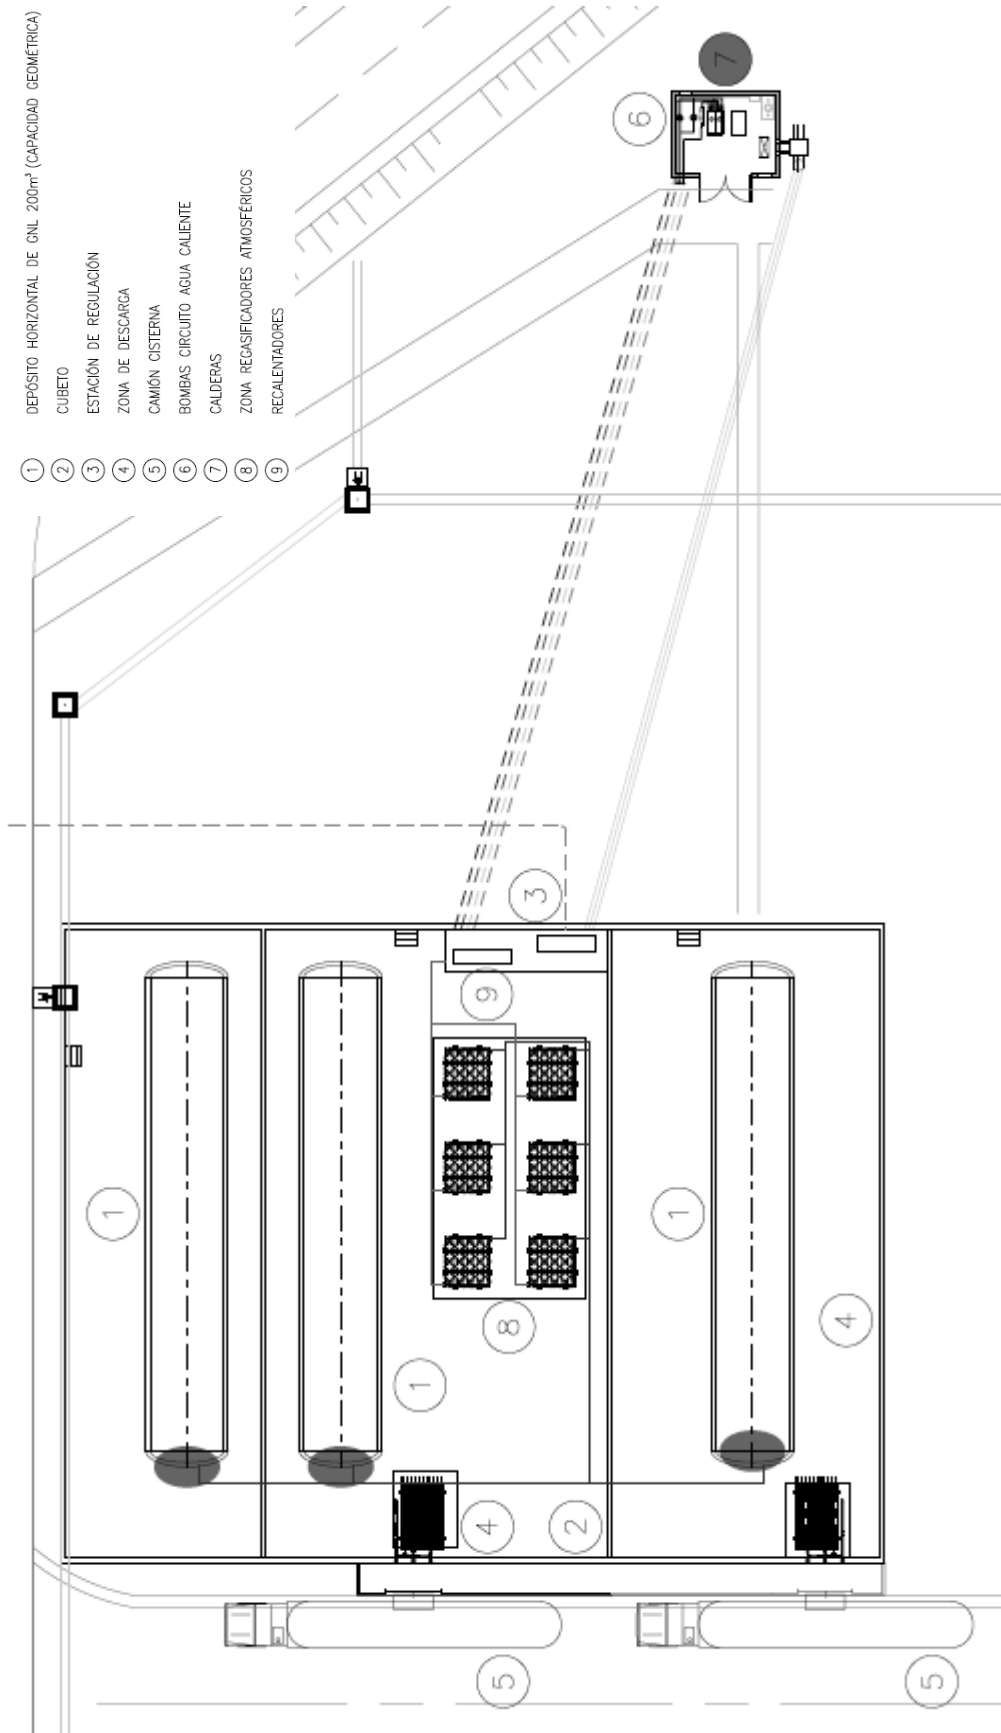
Plano en planta de instalaciones, infraestructuras y equipos.
